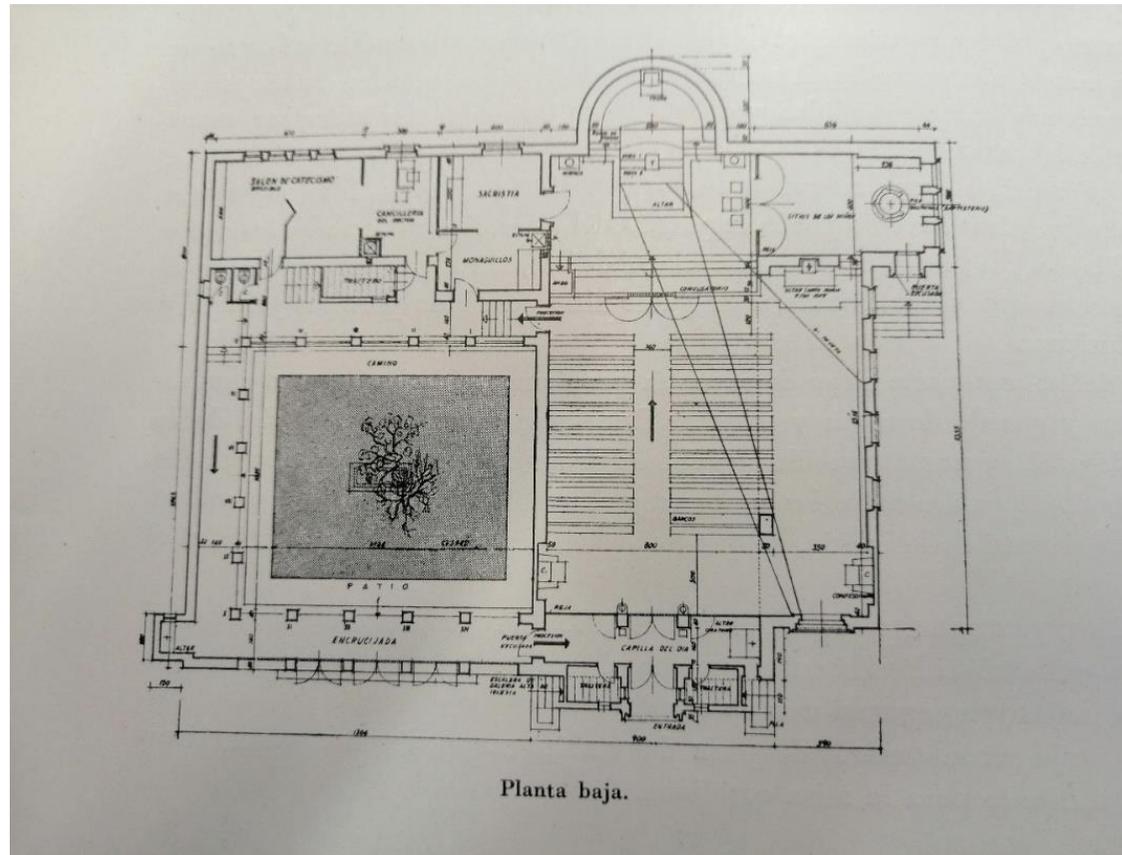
Ntra. Sra. de la Asunción. Planimetría de la planta.
